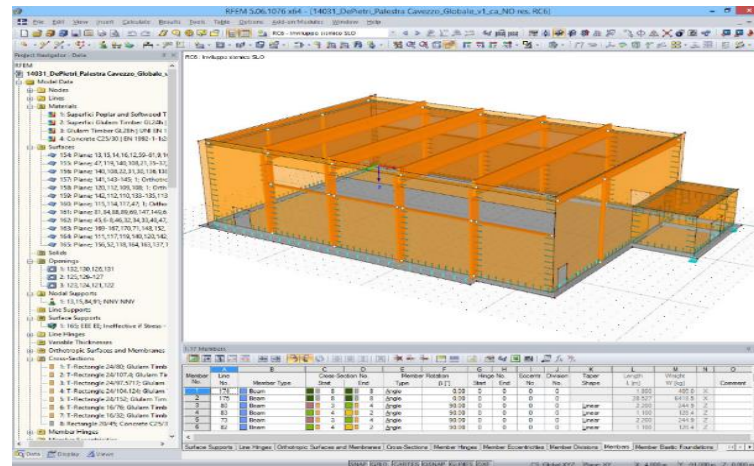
Pavilhão de desportivo “Salvador Allende” em Cavezzo, Itália.
